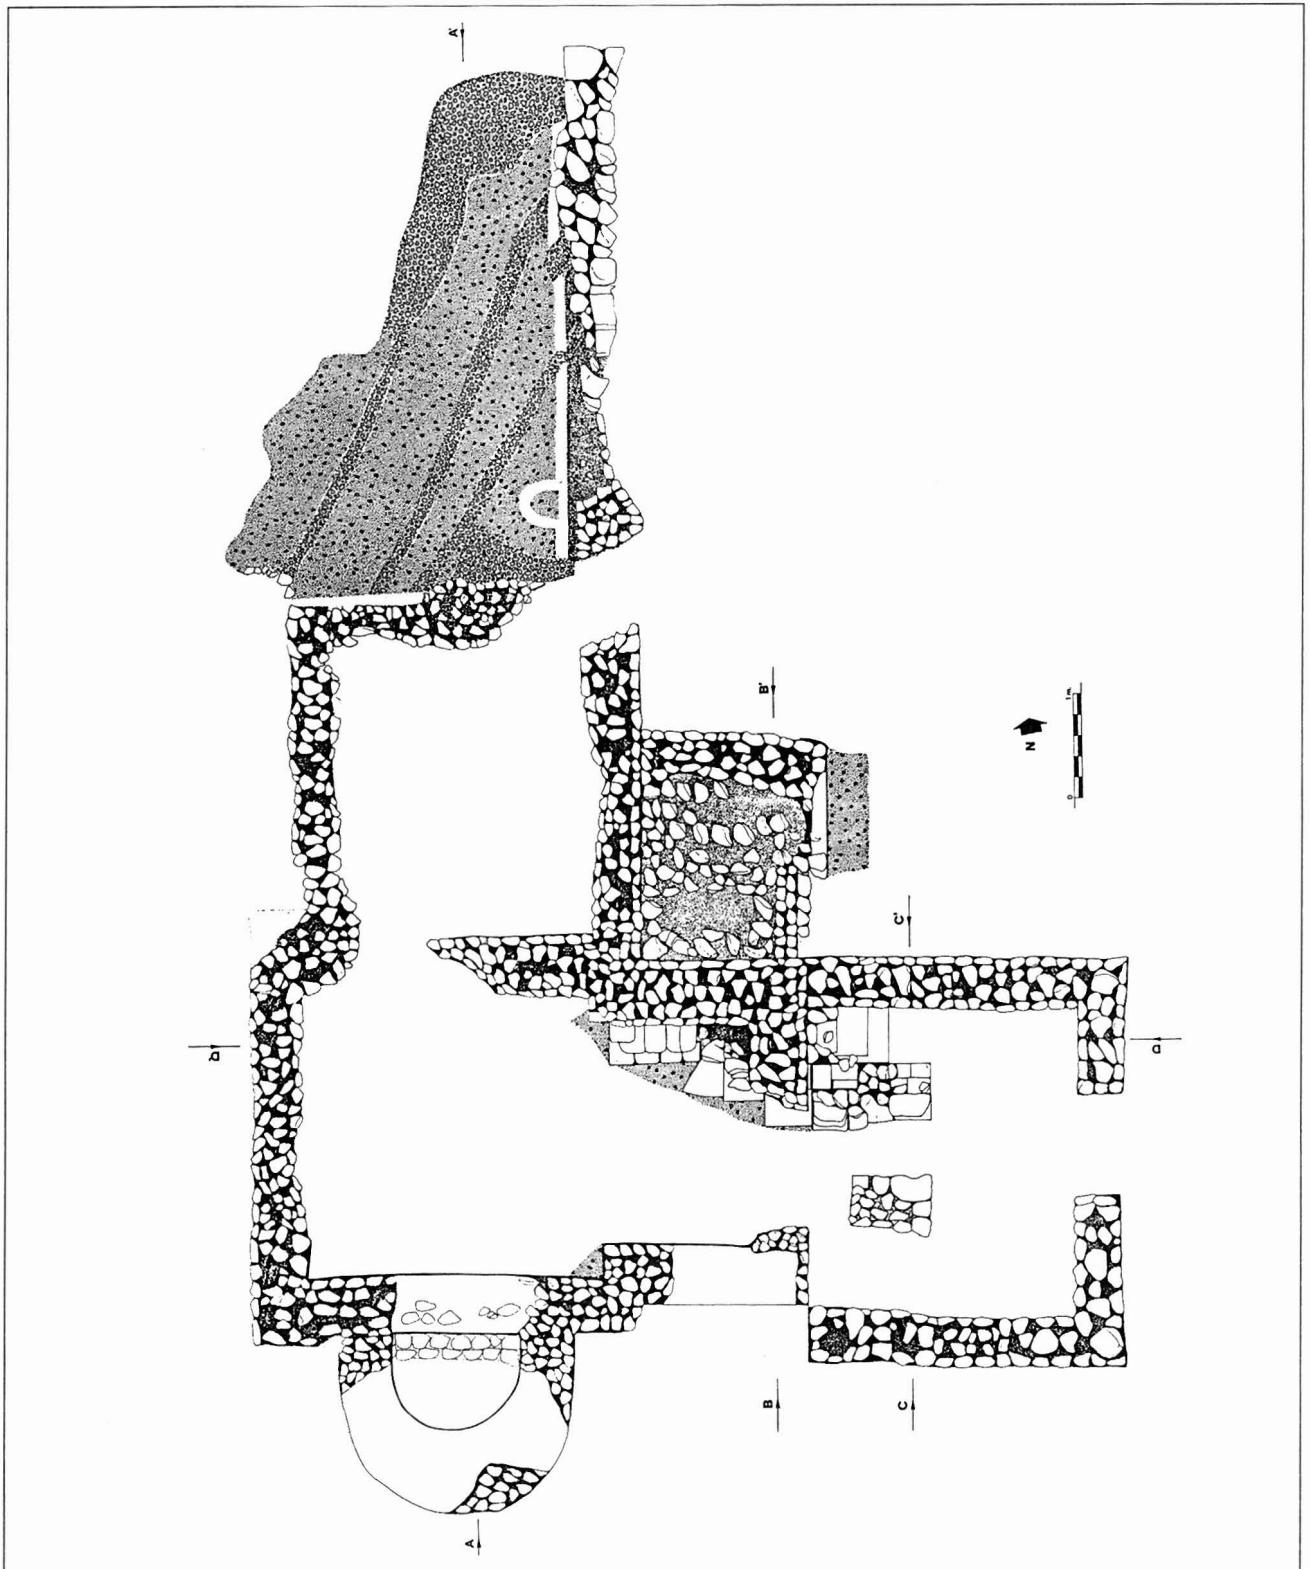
Planta del edificio termal hallado en Balsapintada.
